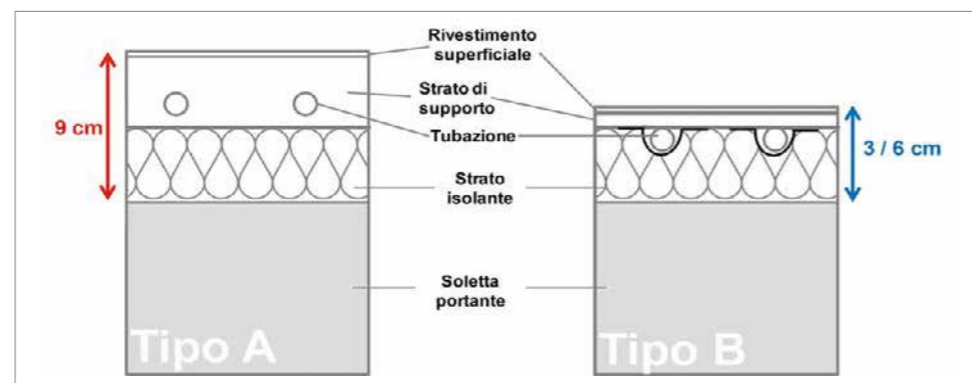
Sistema radiante a pavimento annegato con strato di supporto ad alto e basso spessore.
